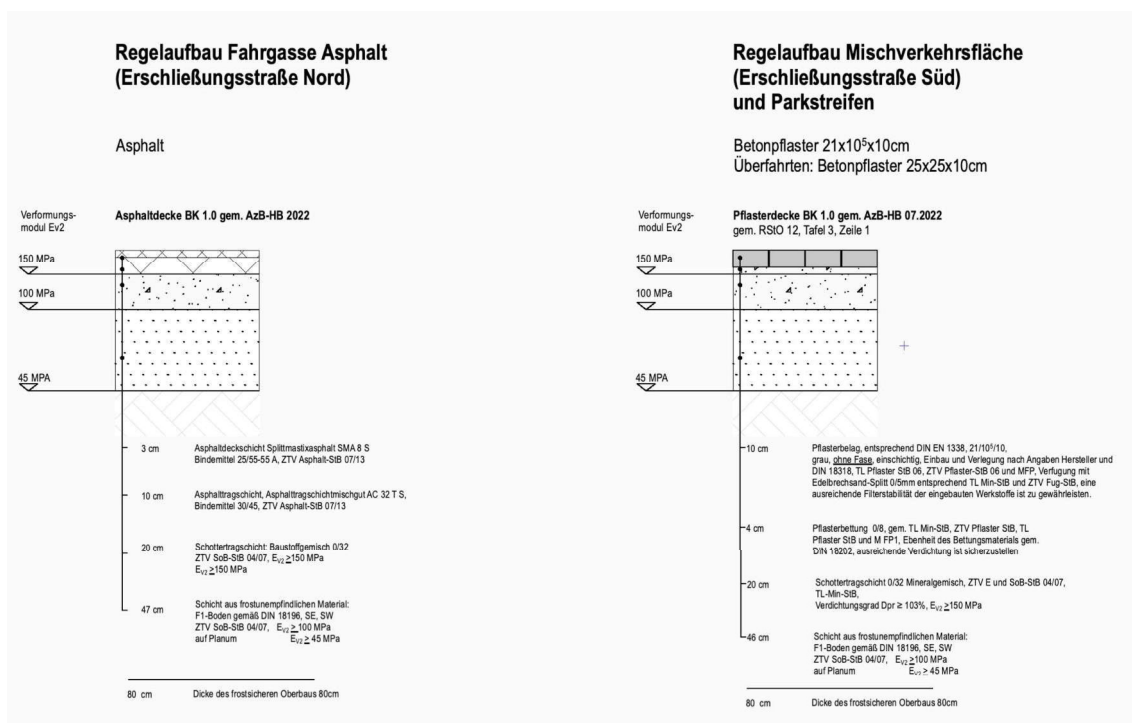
Regelaufbau Verkehrsflächen innerhalb der öffentlichen Erschließung
